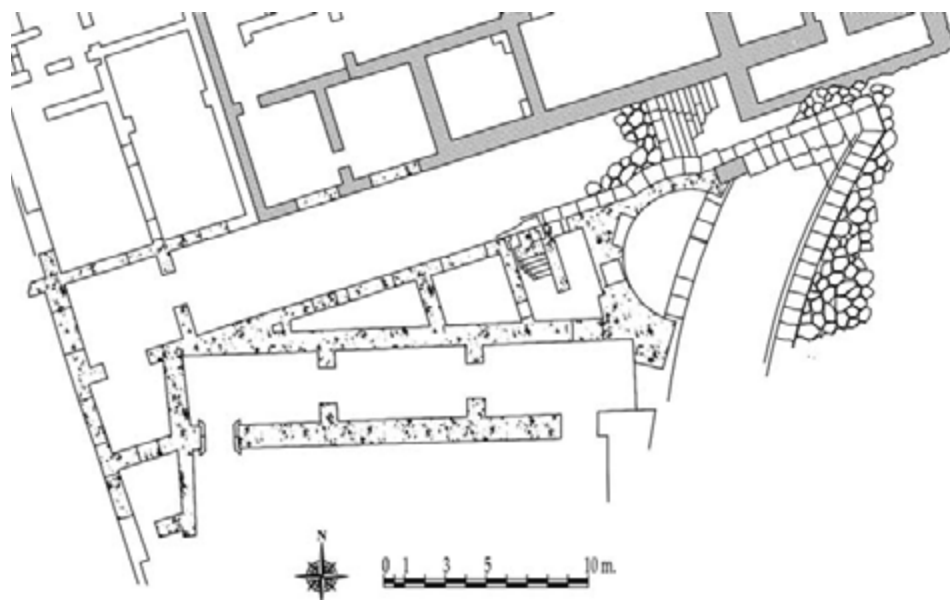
Plano de las excavaciones de Gatti en 1902.
